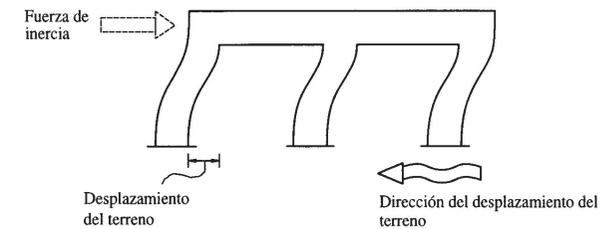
Fuerza de inercia generada por la vibración de la estructura
